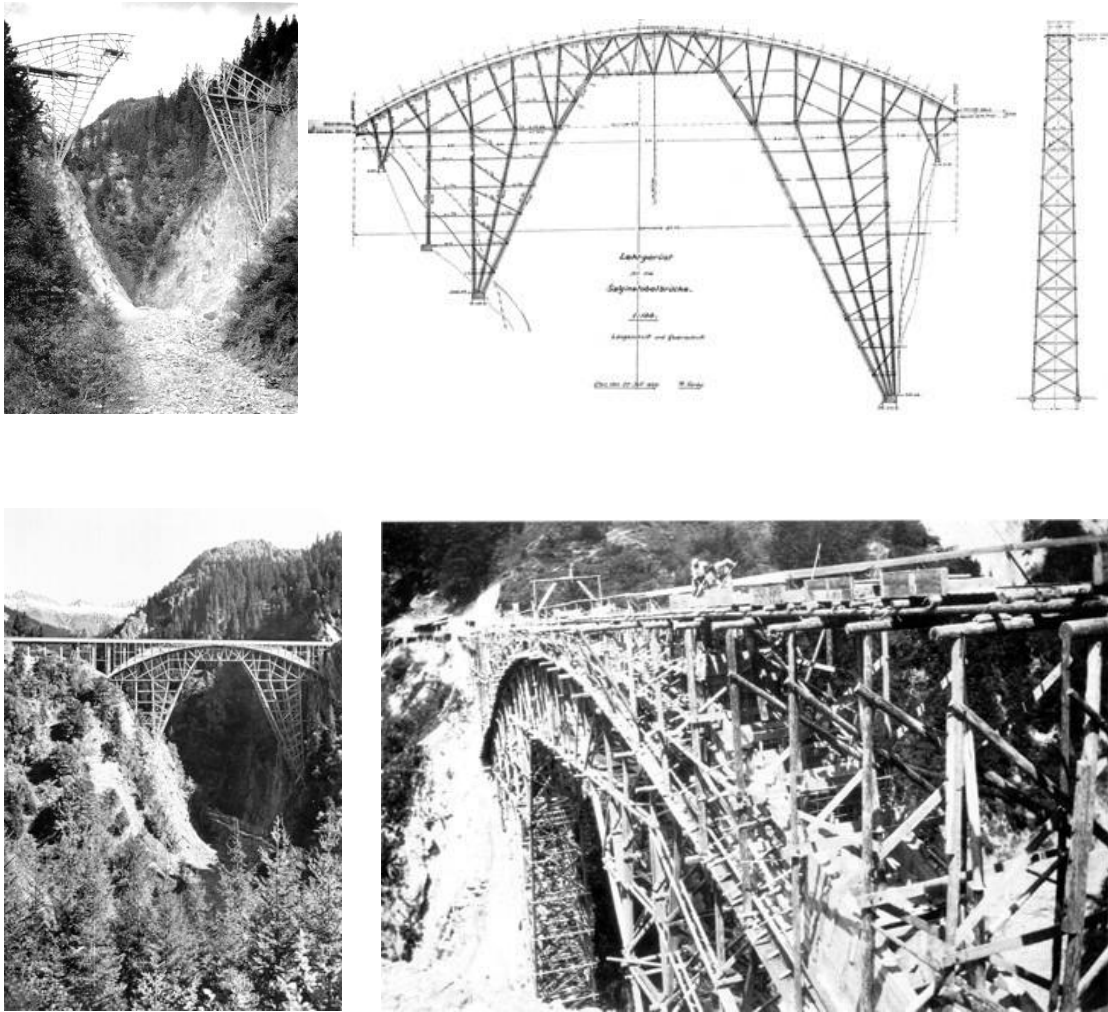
Fotografía del montaje de la estructura del andamio para el encofrado. Plano del andamiaje y distintas fases del hormigonado. Fotos Bibliothek-ETH, Zürich.
